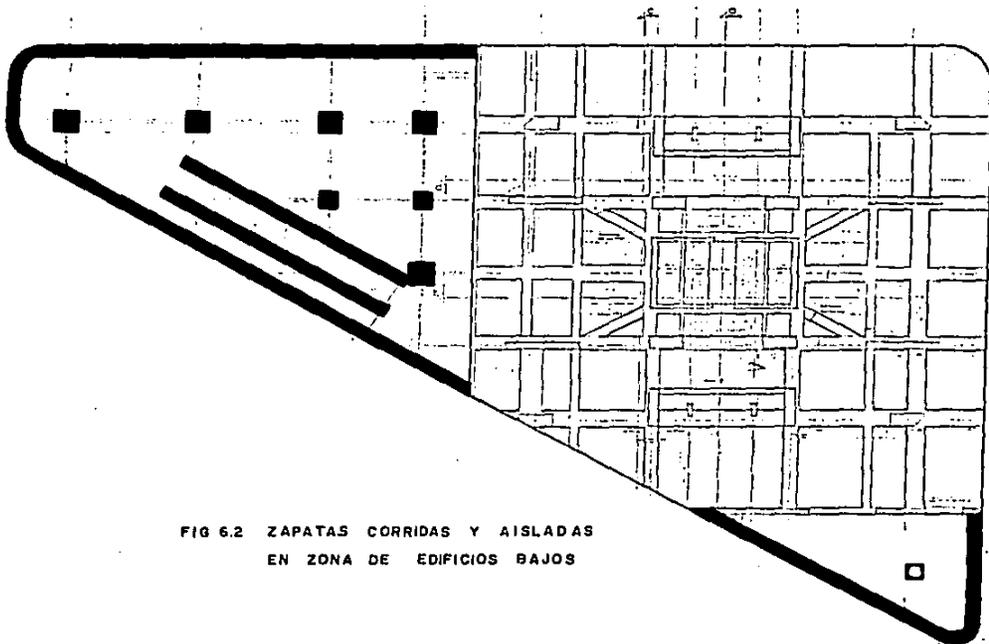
ZAPATAS CORRIDAS Y AISLADAS
